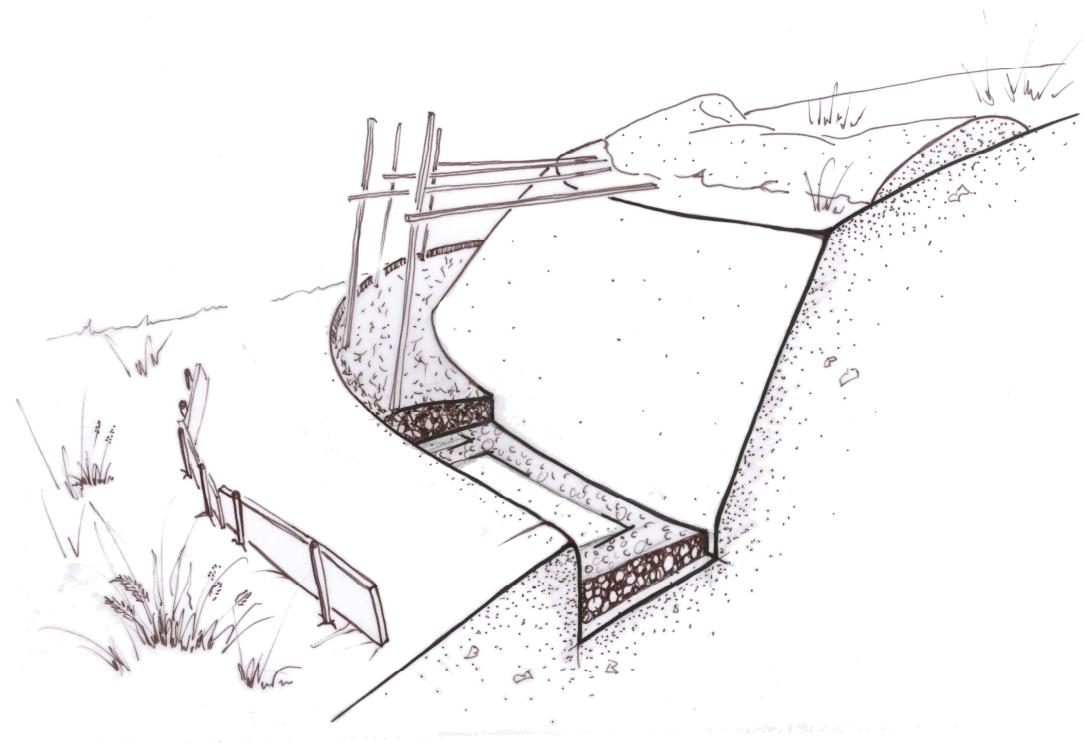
Gerüstaufbau einer Stützmauer (mit Fundations- und Sickerschicht)
